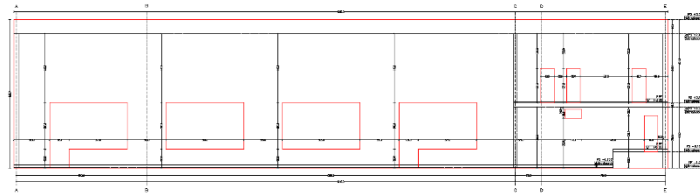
Prospetto nord-ovest setti palestra: strutture in progetto
